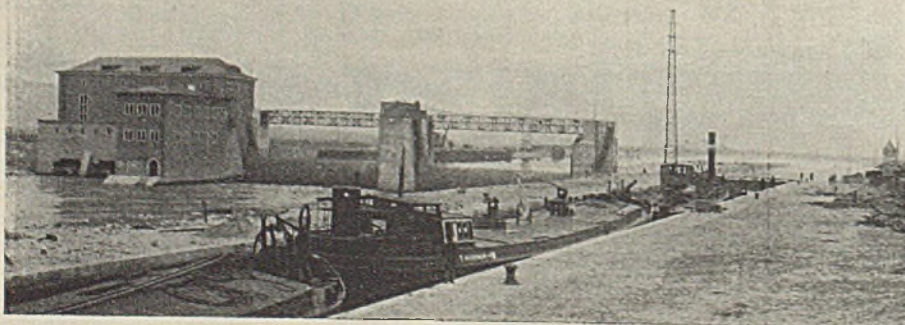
Staustufe Viereth, Blick vom Unterwasser aus.
